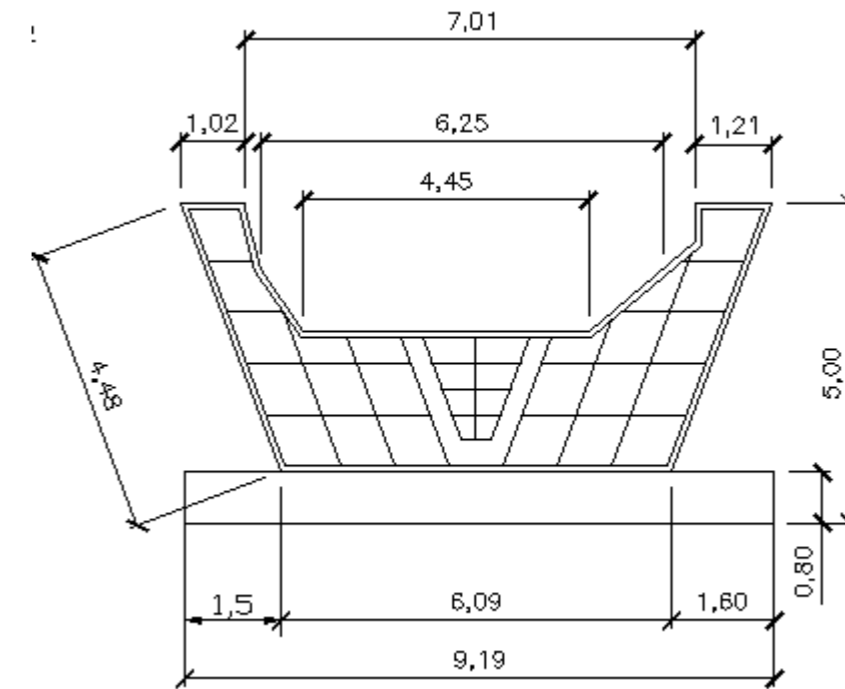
Vista en alzado del diseño propuesto del estribo. Fuente: Elaboración propia.
